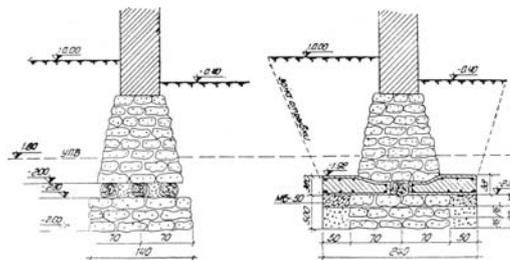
Усиление фундаментов здания на Московском пр., 64 [3]
